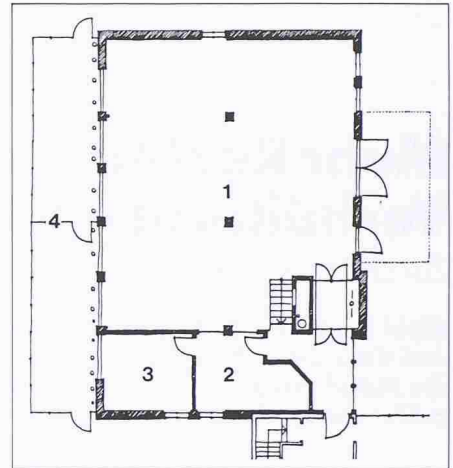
Grundriss Erdgeschoss; 1 Werkhalle, 2 Spedition, 3 Labor, 4 Gewächshaus
